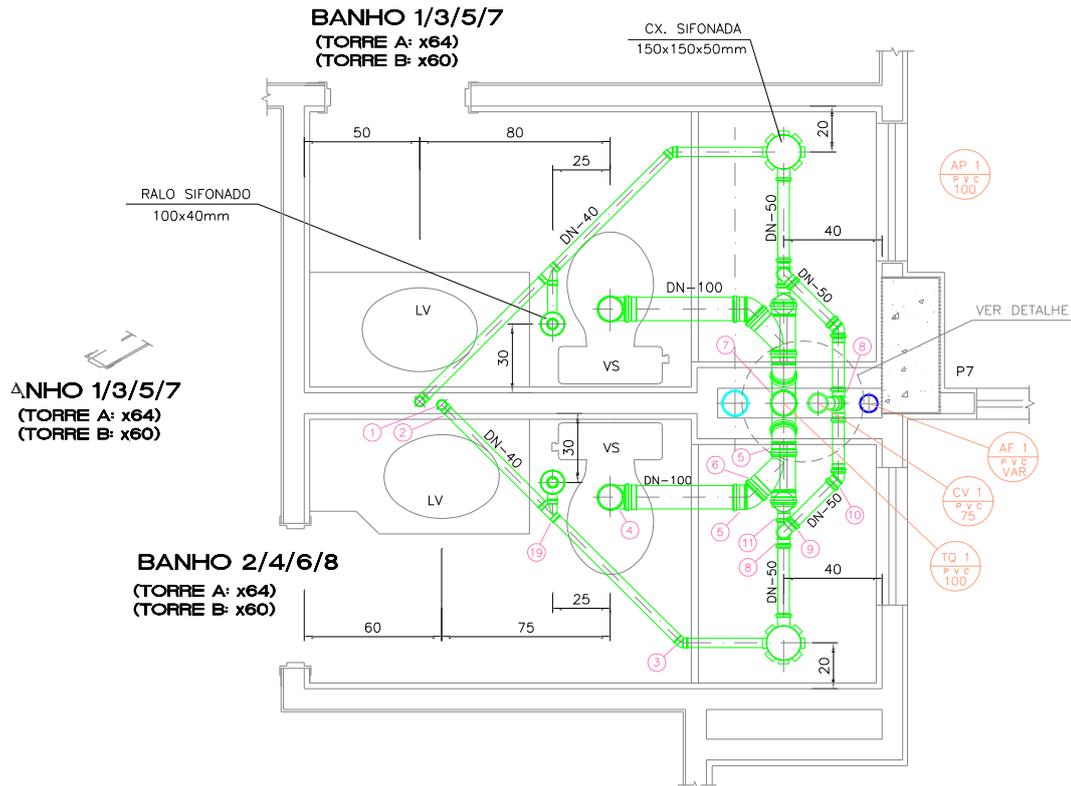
Detalhe da instalação de esgoto sanitário dos banheiros
